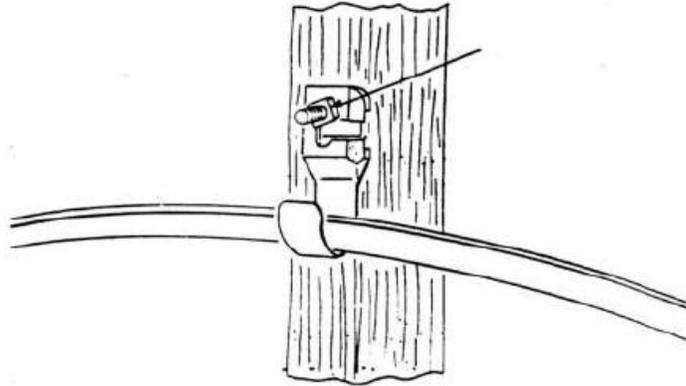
Colocación del gancho de soporte temporal del cable autoportado.
